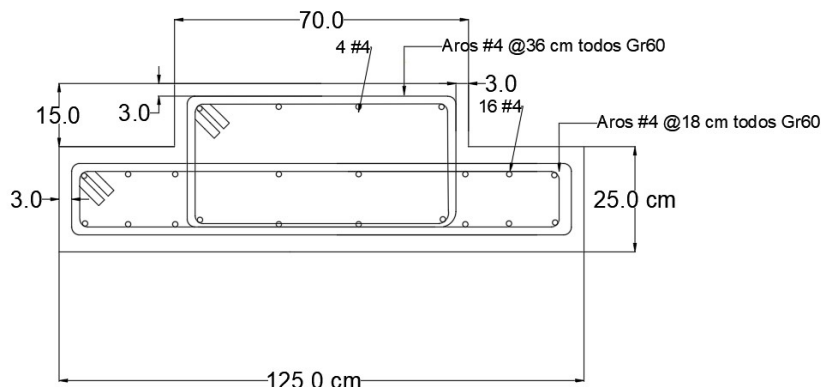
Detalle de sección transversal de cimentación tipo 2.
